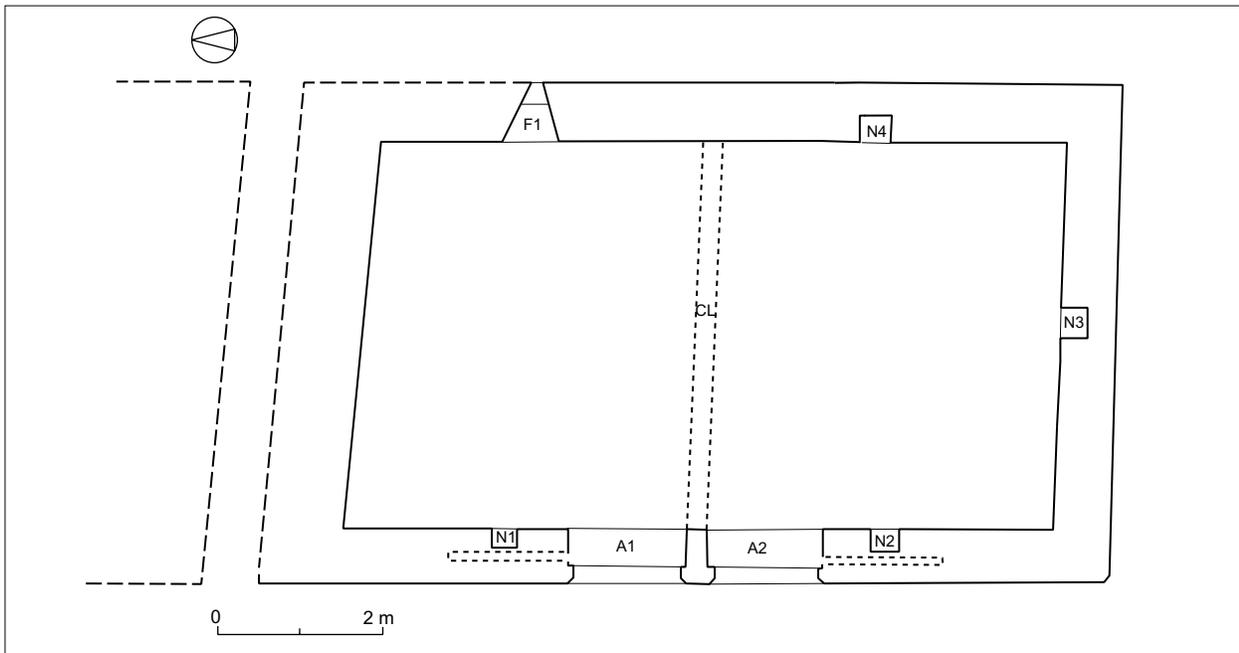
MAISONS JUMELLES N° 1. Plan du rez-de-chaussée : proposition de restitution des dispositions du XIII<sup>e</sup> siècle. Dessin V. Rousset, 2001.
